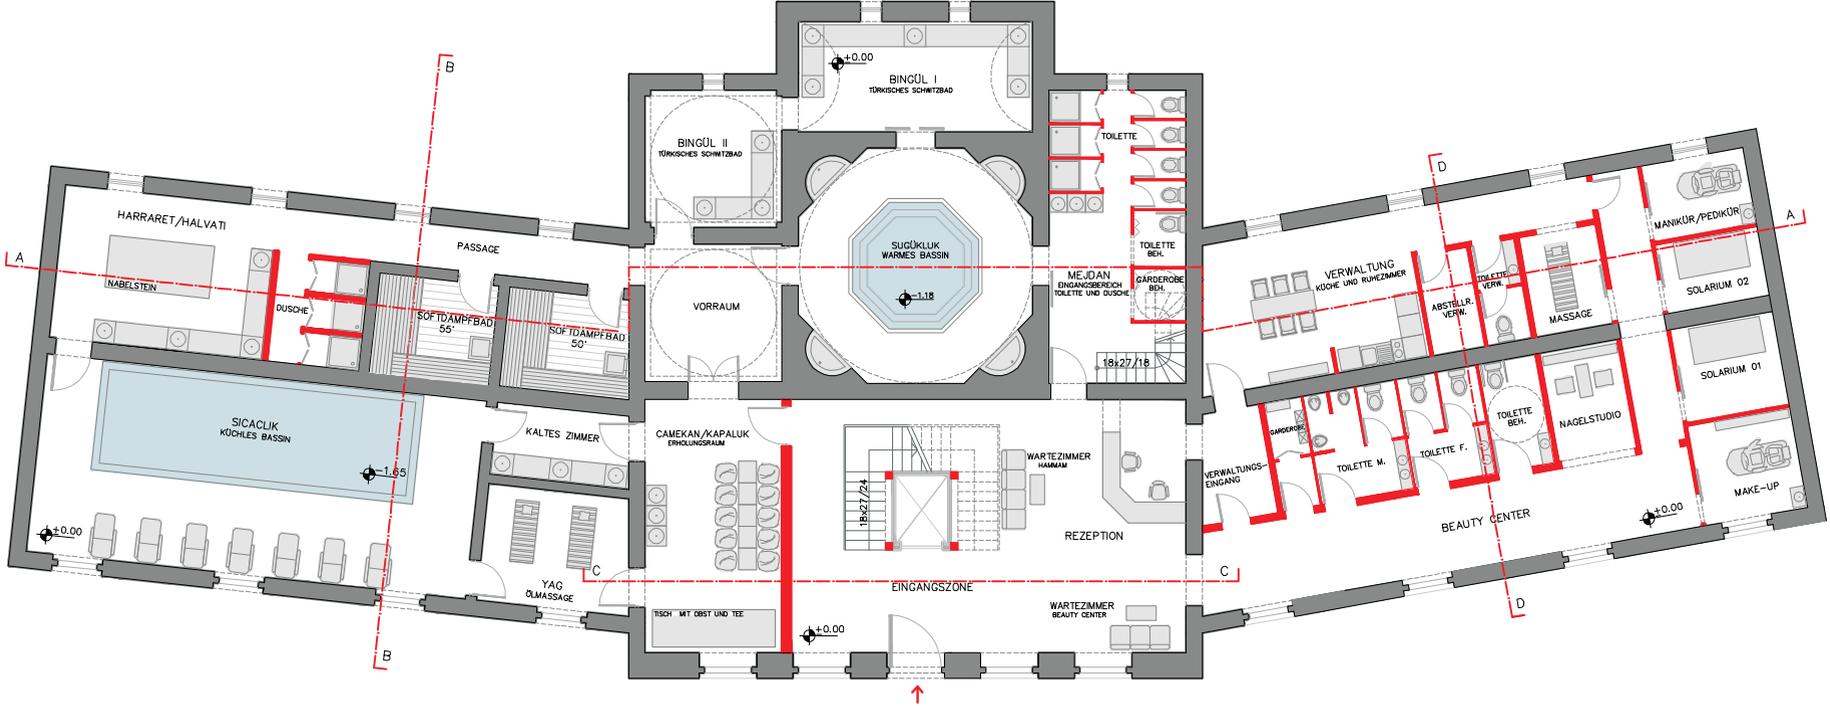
Neuer Grundriss Erdgeschoss\_Funktionen
